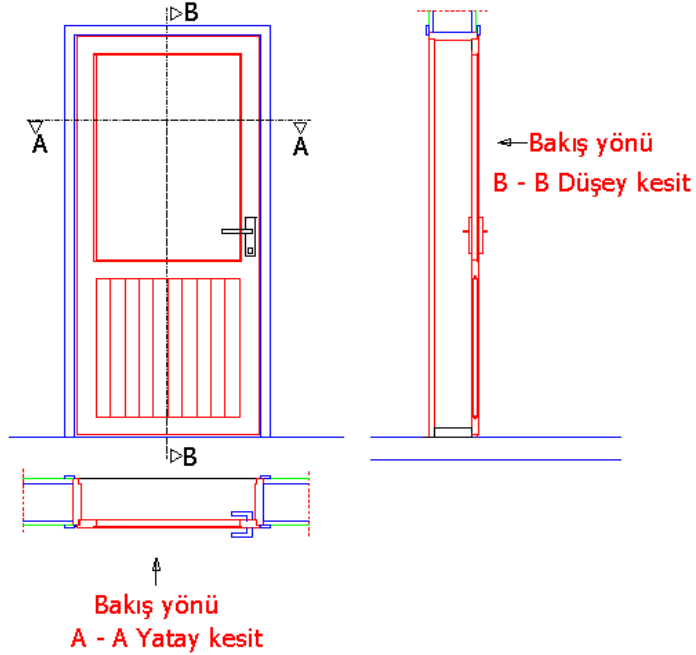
Görünüş çizimi için plan ve kesitten ölçülerin taşınması
